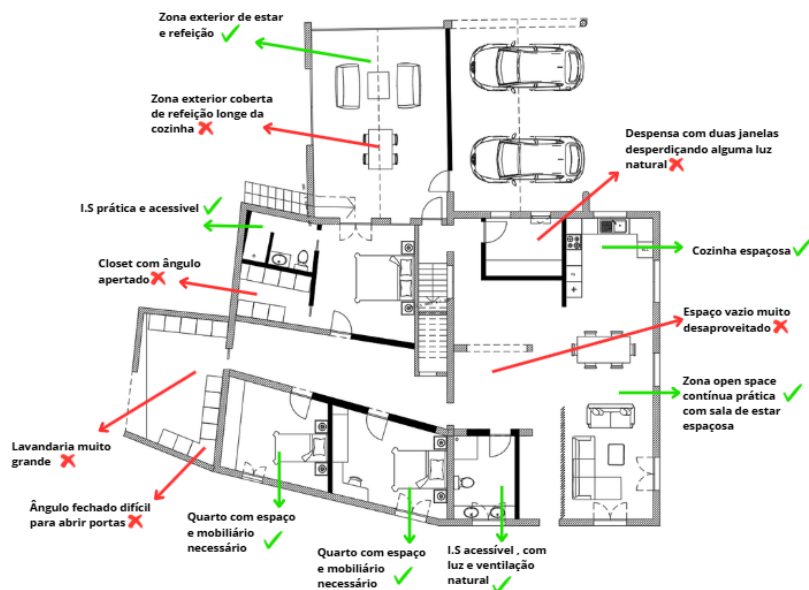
Análise de planta esboço, proposta 4, piso 0
